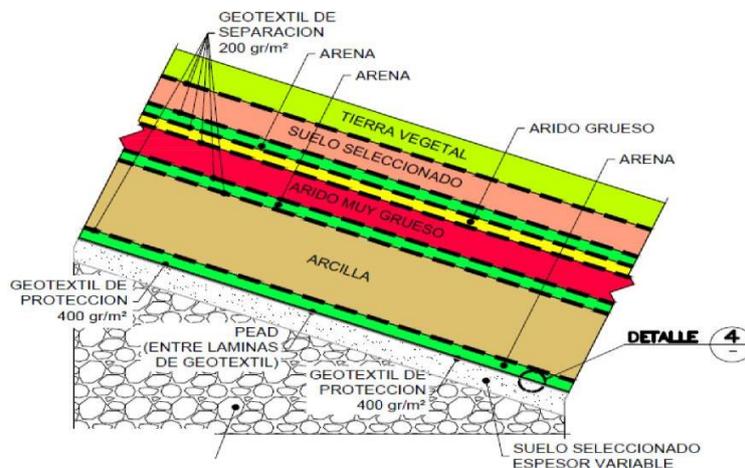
Detalle de las capas de la cobertura de la celda N° 5
